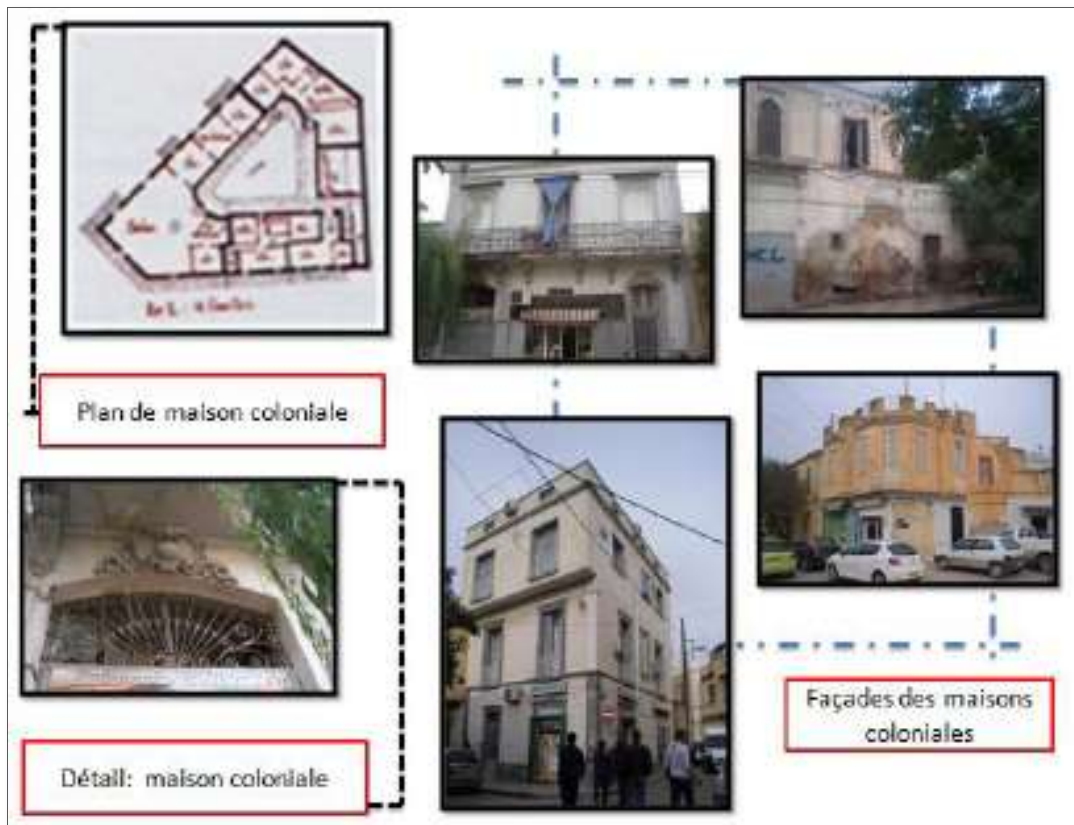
plan + façades + détail d'une maison coloniale (rue de paris-Tlemcen)
